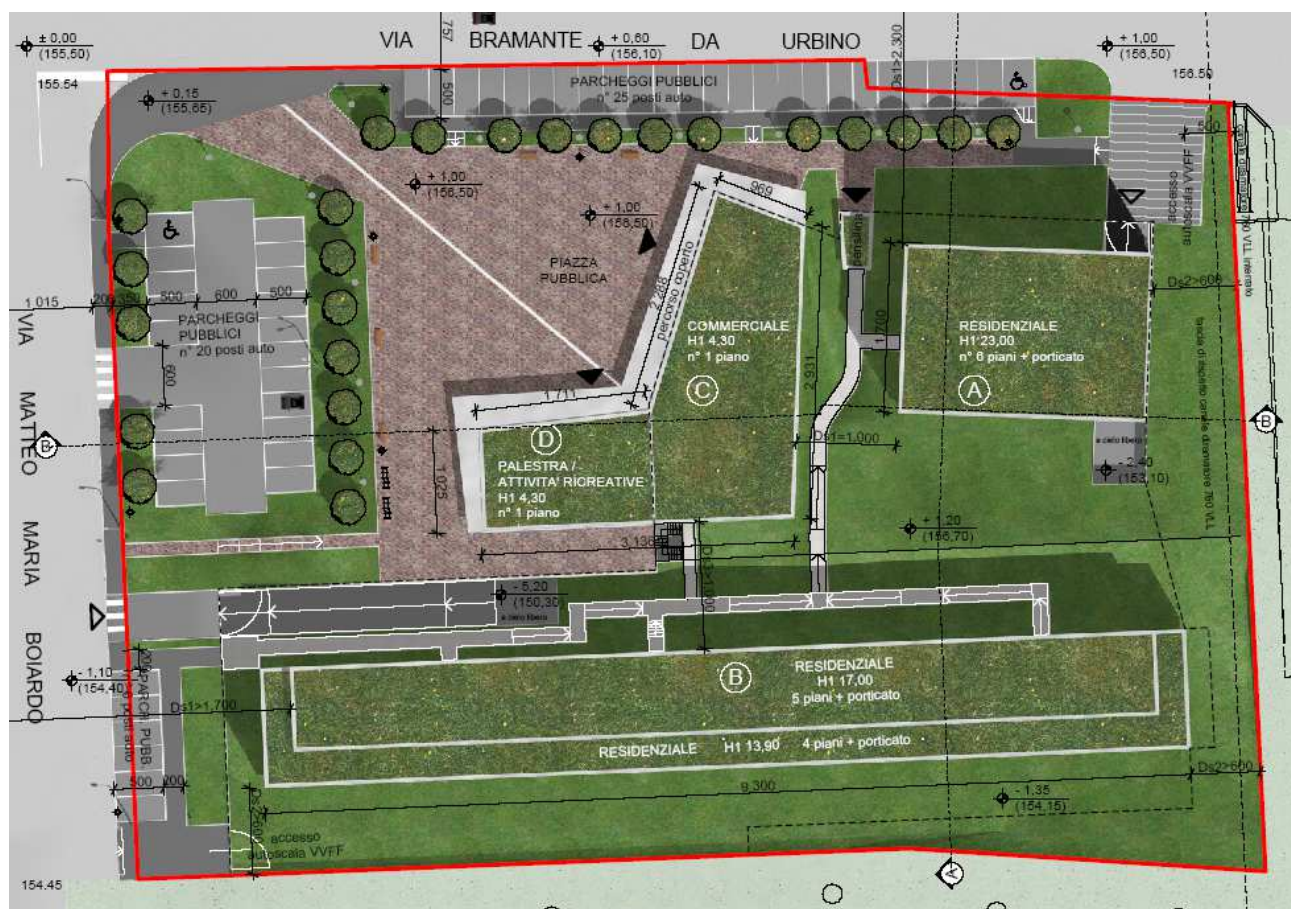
Planivolumetrico del P.I.I. di futura edificazione
